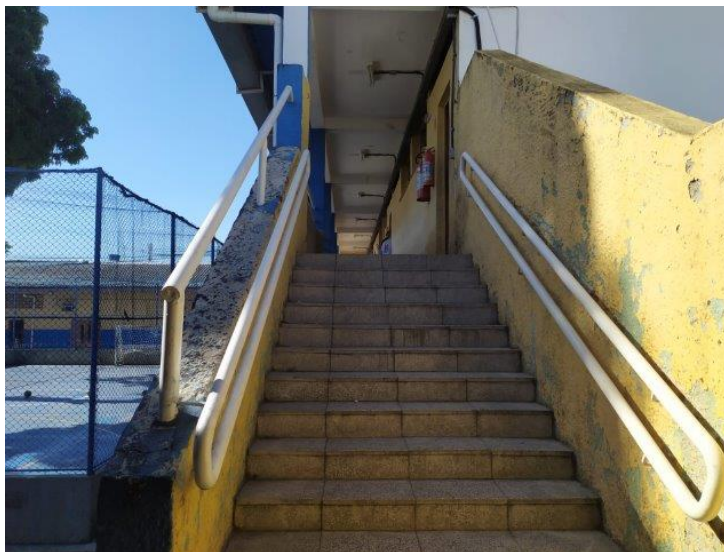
Escada 04 – escada de acesso ao pavimento superior
